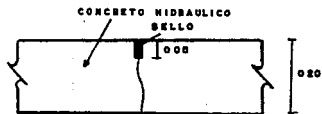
JUNTA DE CONTRACCION TRANSVERSAL
